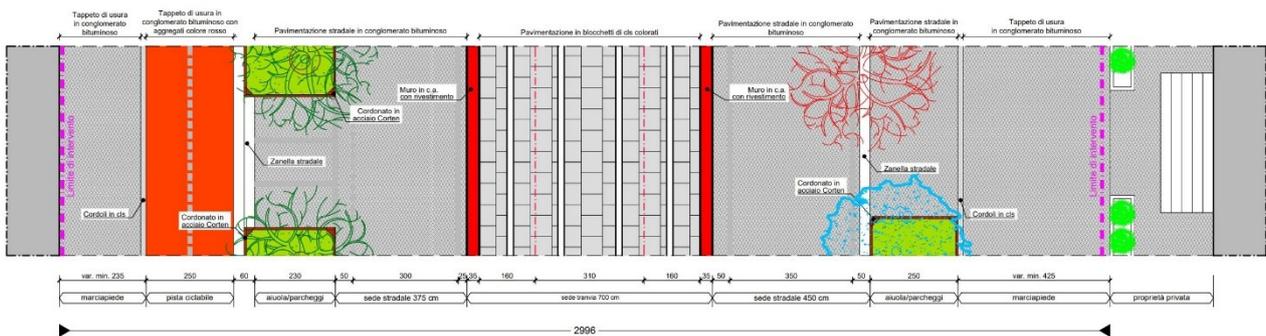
Stralcio planimetrico della rampa del sottopasso su viale Don Minzoni
